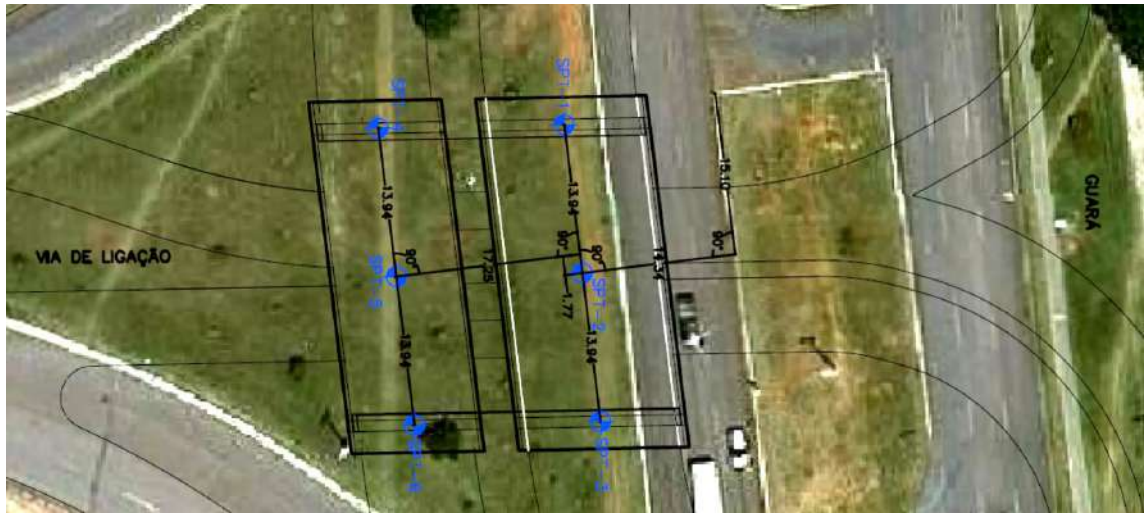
Vista Geral Locação das Sondagens – Viaduto do Contorno
